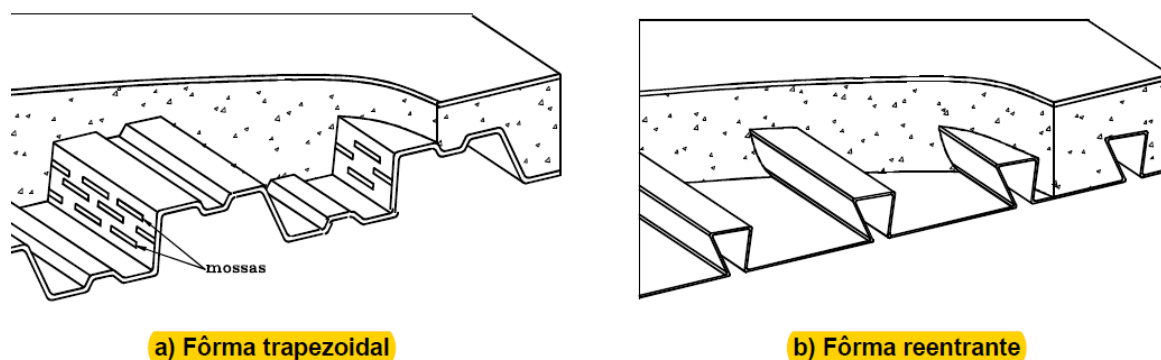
Lajes mistas de aço e concreto. Fonte: ABNT NBR 8800:2008
